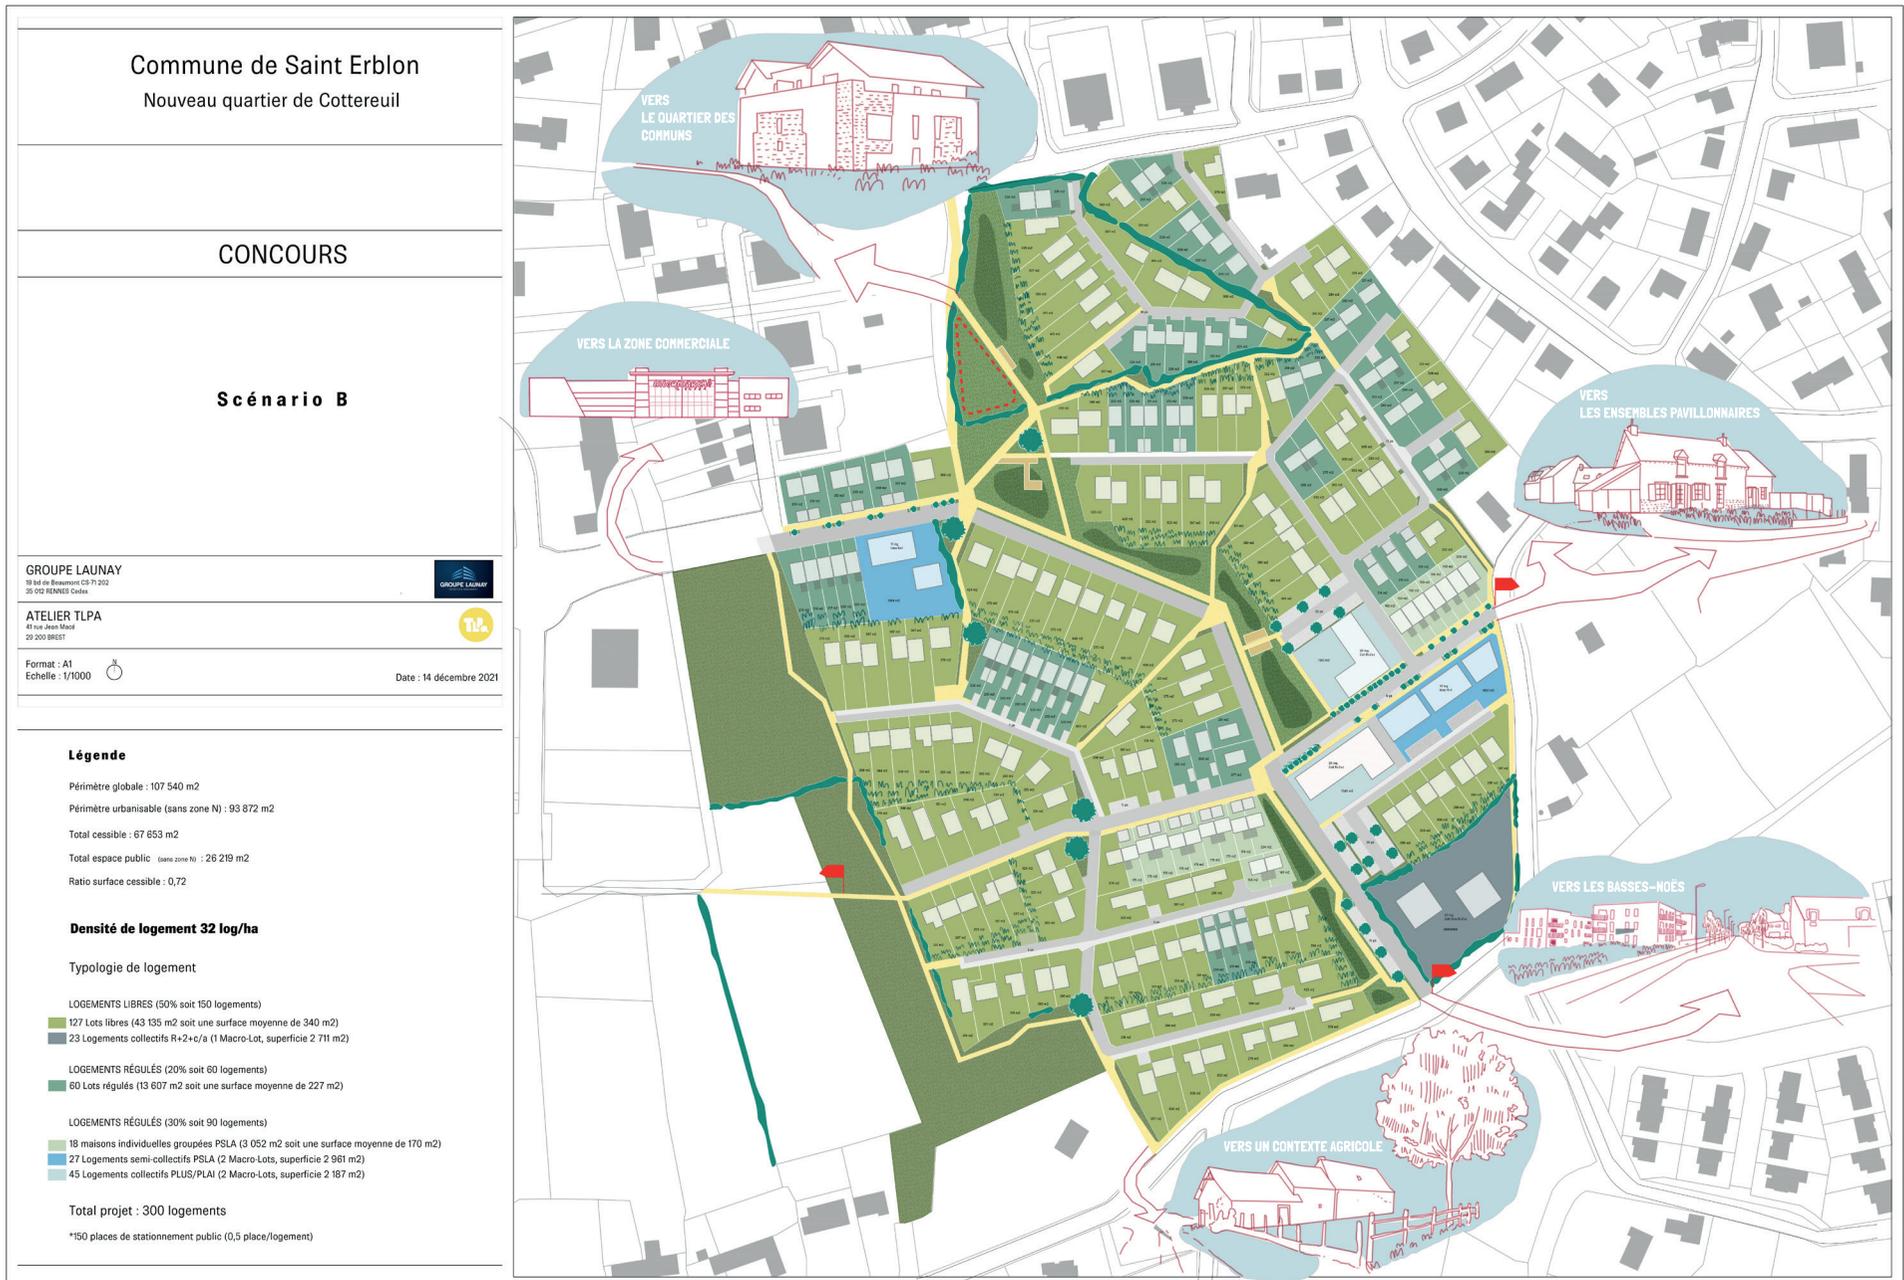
Plan de masse issu du concours d'architecte (densité de 32 logements/ha) - TLPA
